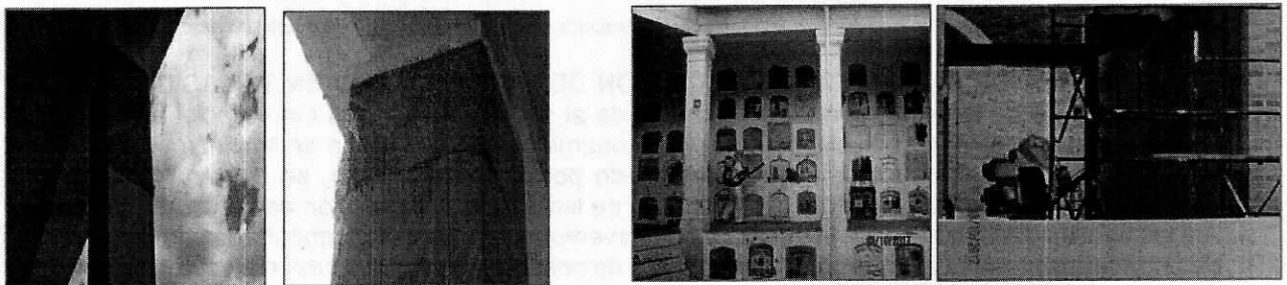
Instalación de mampara Cementerios Sur y Central
